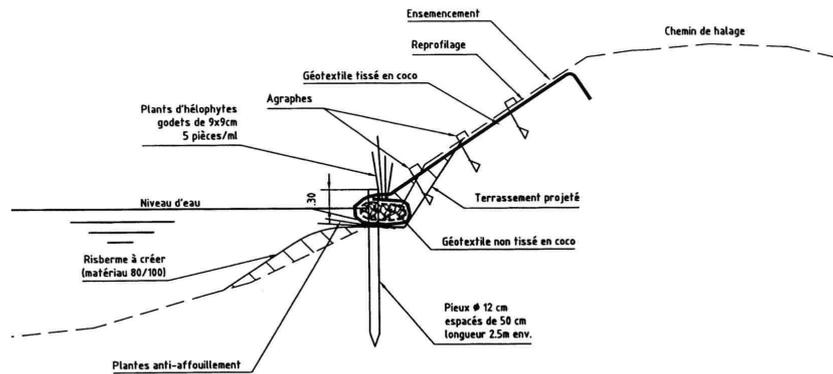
Coupe transversale du dispositif [Source VNF/Ingédia]
